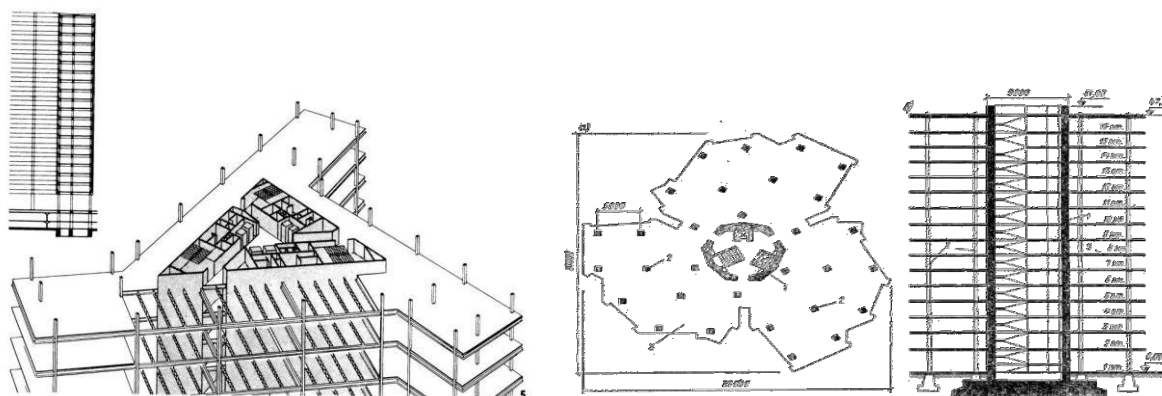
Конструктивные схемы монолитных железобетонных каркасов с несущим монолитным ядром жесткости
